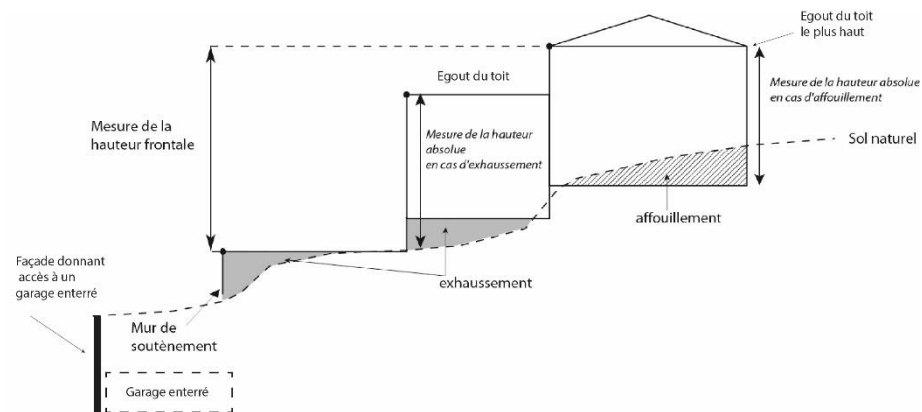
Illustration des modalités de calcul de la hauteur des constructions
